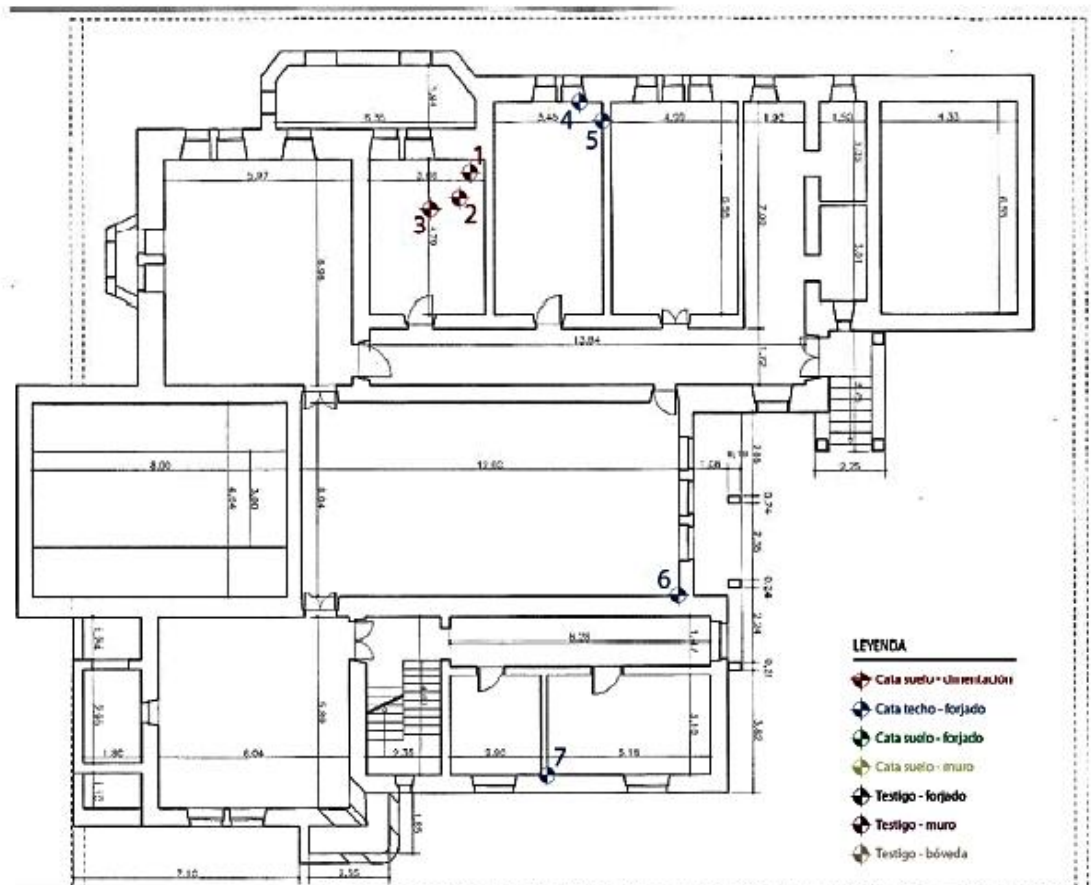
Ubicación extracción de testigos Planta Sótano. Villa el castillito. Sanlúcar de Barrameda. (Fuente Songea)
